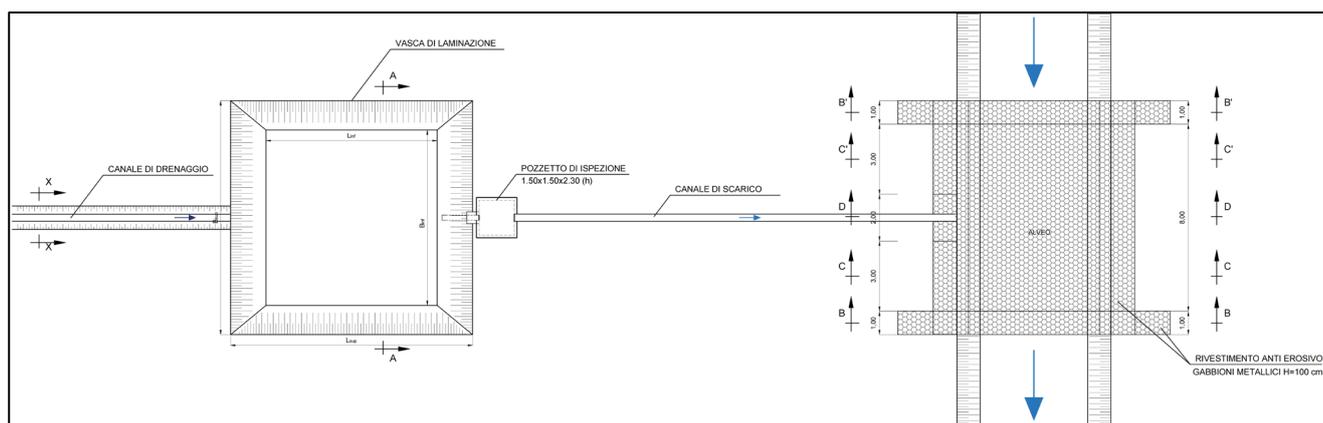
Planimetria Sistema vasca di laminazione e recapito
